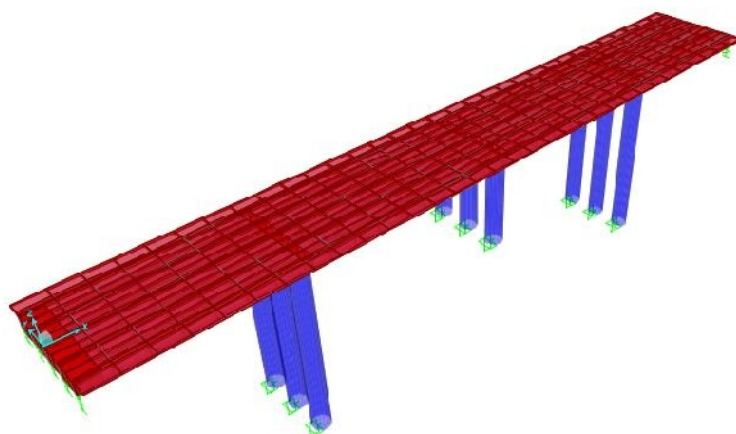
Puente en Vista de Elevación 1 (Fuente: elaboración propia)
